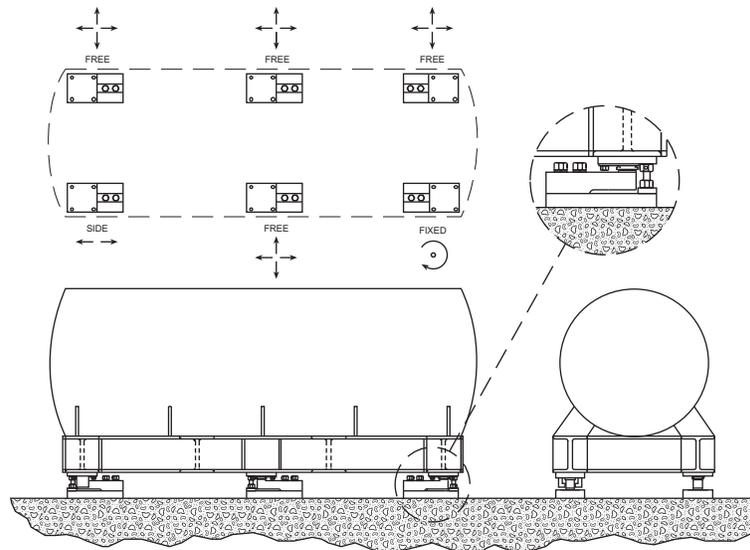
Sistema de montaje Paramounts en tanque cilíndrico
